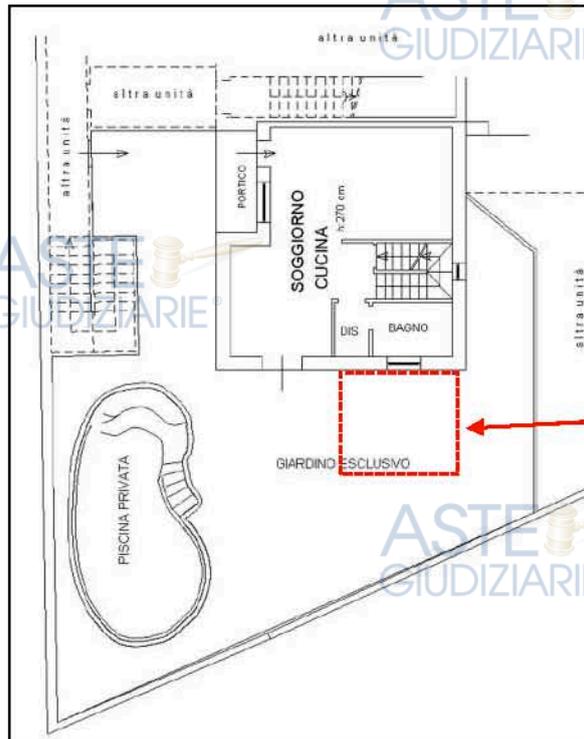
planimetria piano interrato con indicate le difformità rilevate (schema indicativo)
